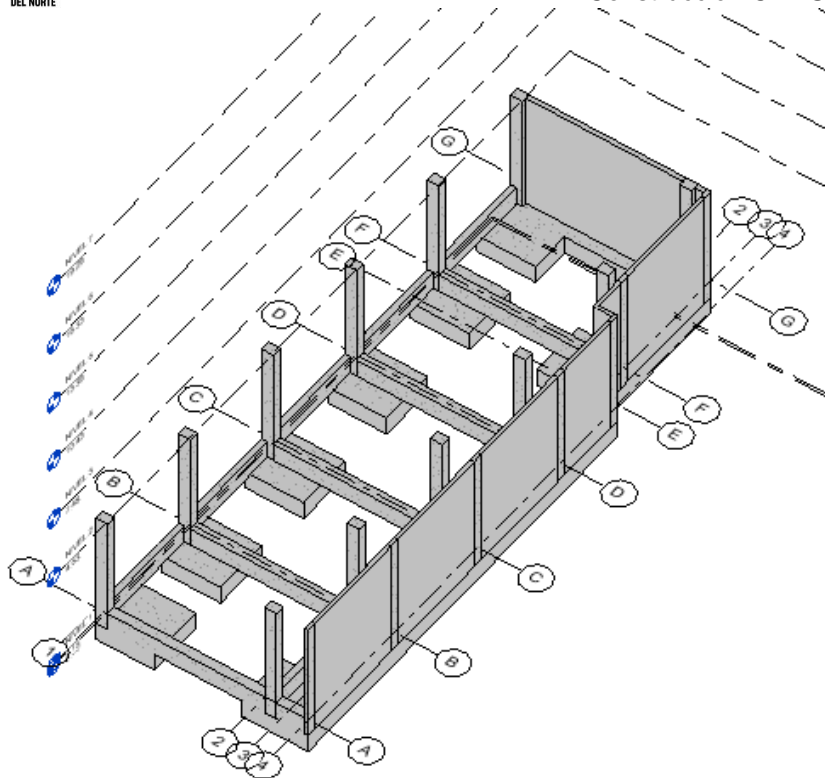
Vista 3D de distribución de placas, columnas y cimentaciones (Fuente: Elaboración Propia).
